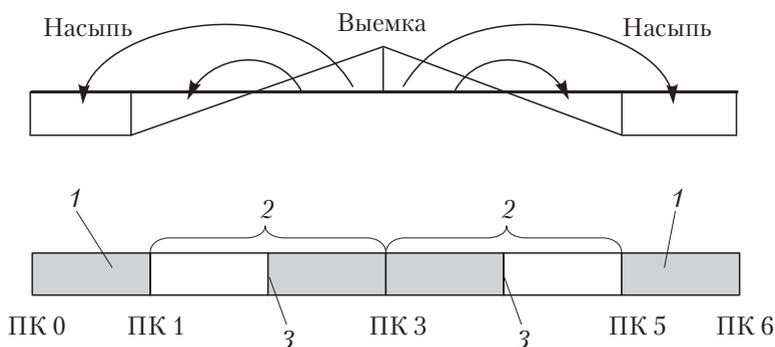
Схема перемещения грунта из выемки в насыпь при расположении выемки в середине участка:
